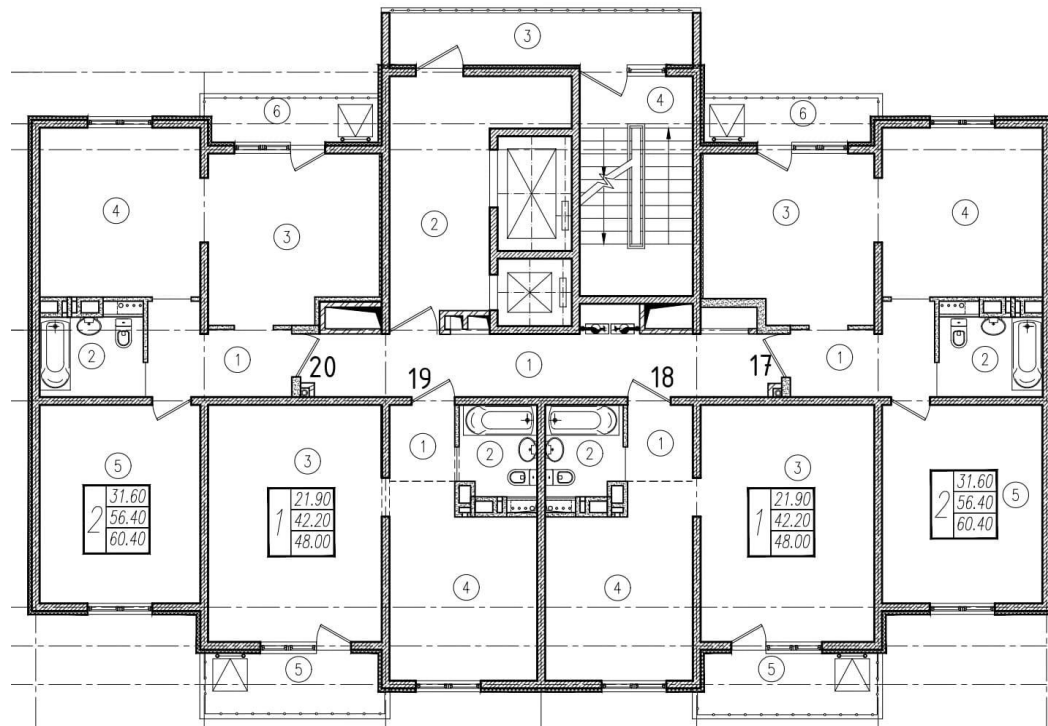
План 6-16-ого этажей 6 литеры ЖК «Горный квартал»
